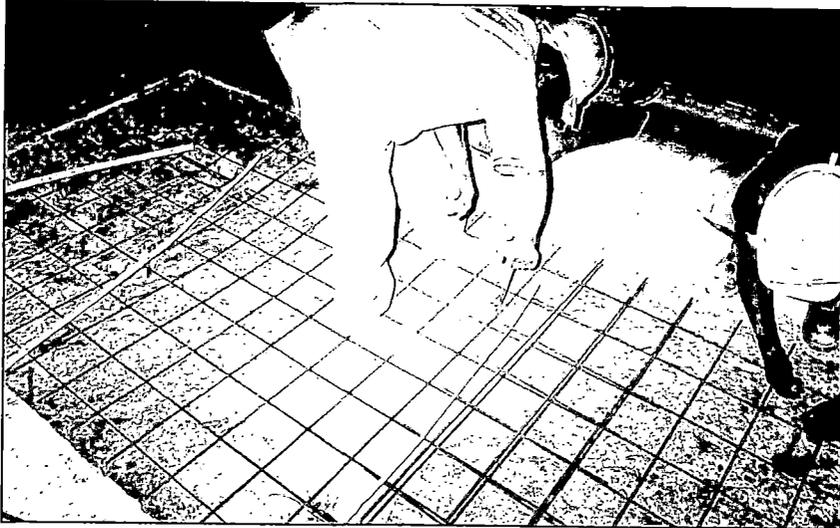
Colocación de la malla electrosoldada Q-238
